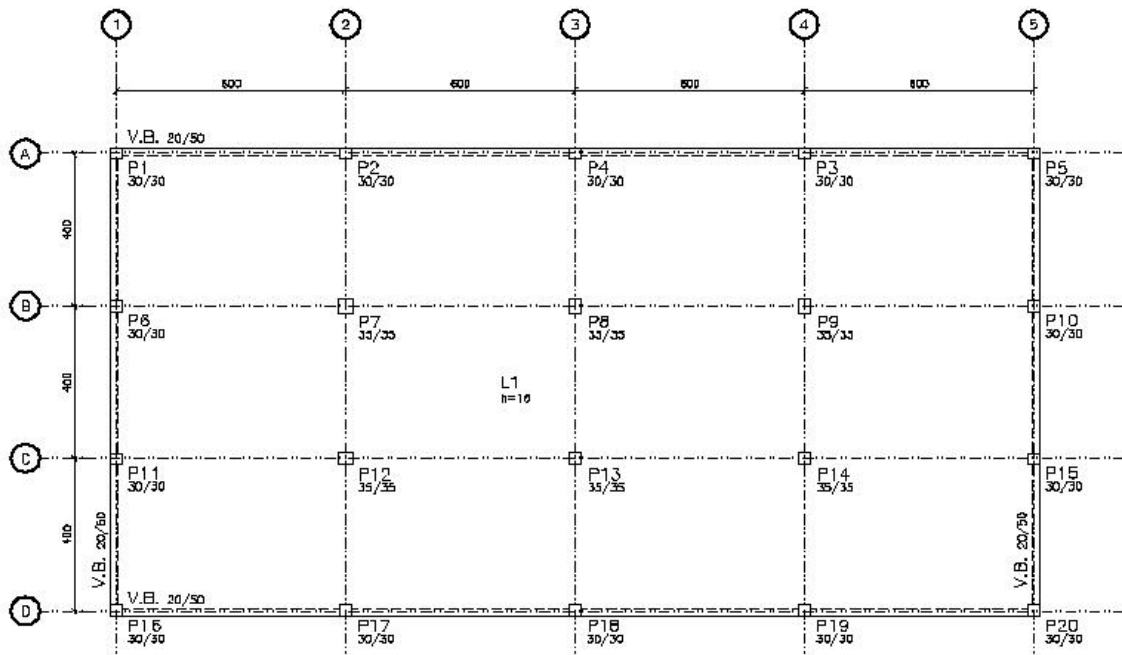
Planta do pavimento em malha retangular (tipo A).
